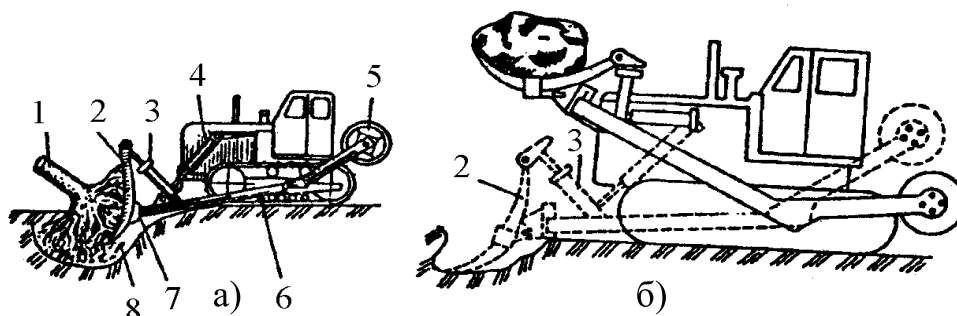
Корчеватель-собиратель МП-2А: а – при корчевке; б – при погрузке; 1 – корчуемый пень; 2 – отвал; 3 – гидроцилиндр поворота; 4 – гидроцилиндр подъема; 5 – противовес; 6 – рама толкающая; 7 – кронштейн; 8 – зубья
